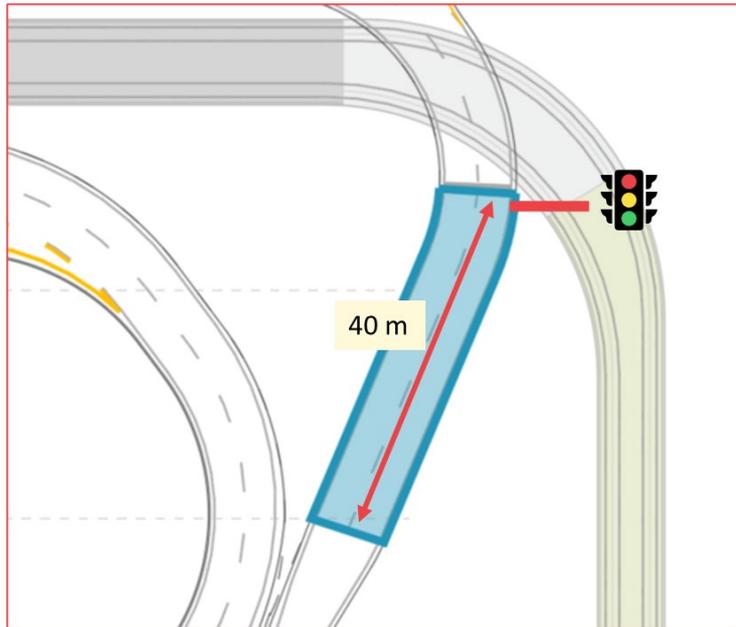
Dettaglio planimetrico intersezioni con tramvia
